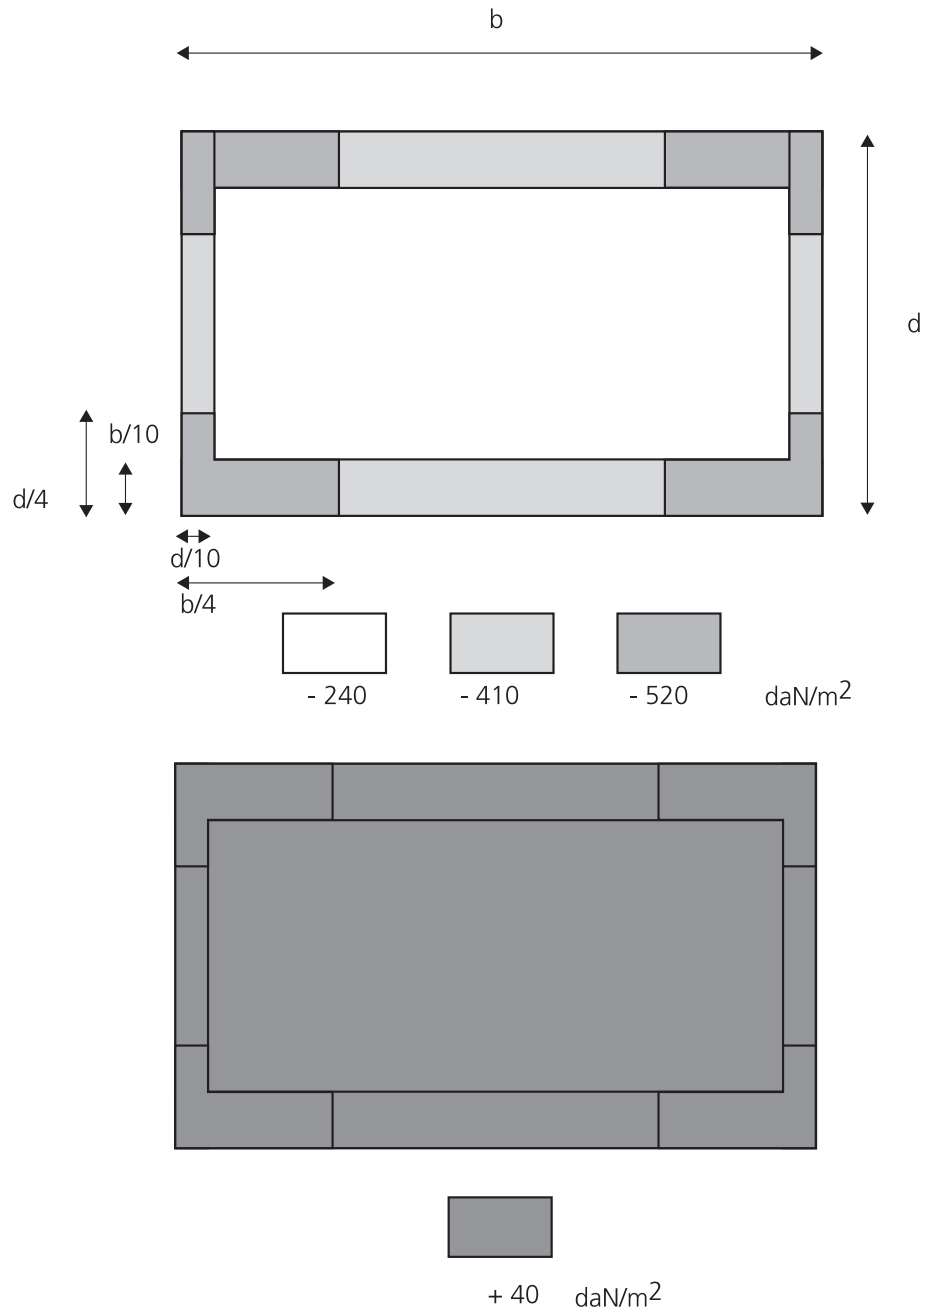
Charges forfaitaires d'arrachement et d'écrasement sur une toiture terrasse, $h \leq 10$ m
